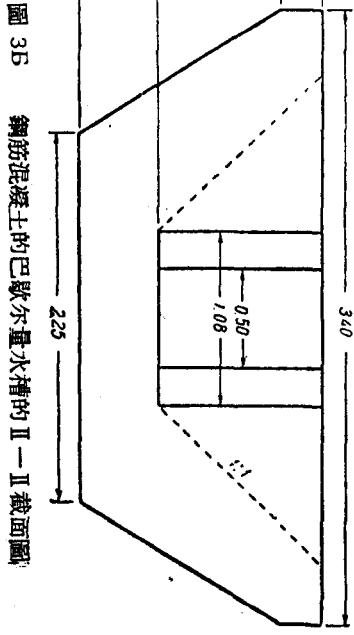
鋼筋混凝土的巴歇爾量水槽的 II-II 截面圖
